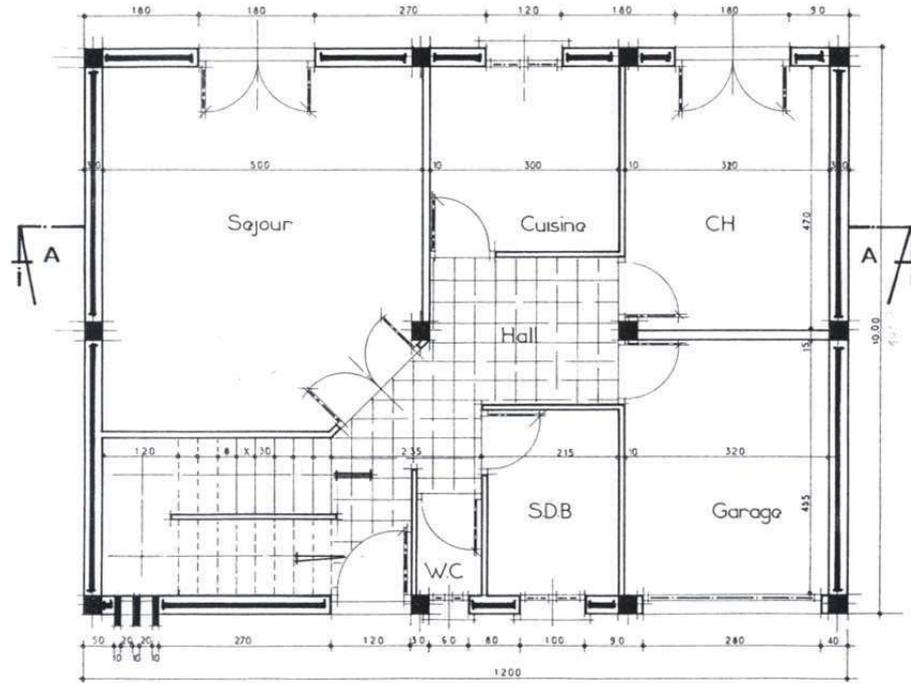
Plan du rez-de-chaussée d'un logement individuel
